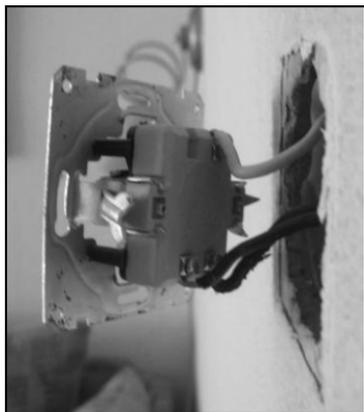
Выключатель с подсоединенными электрическими проводами перед установкой на штатное место — в стену
